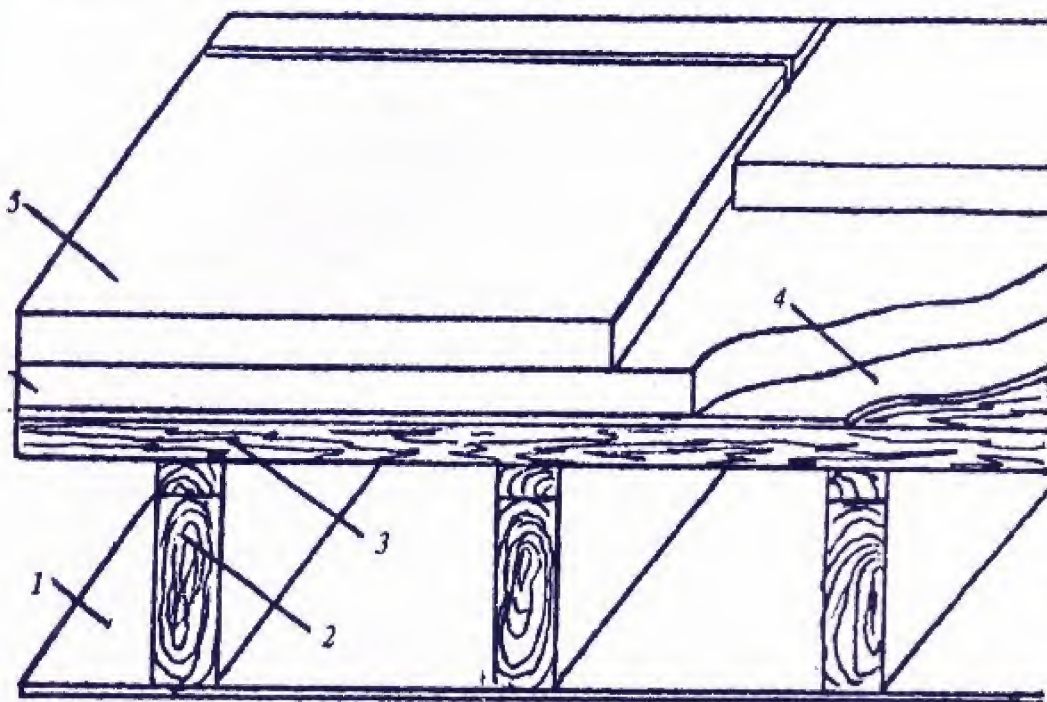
Зовнішнє утеплення плоского даху: 1 – стеля; 2 – брус несучої конструкції; 3 – дерев'яна панель; 4 – гідроізоляційне покриття; 5 – теплоізоляційний шар; 6 – тротуарна плитка.
